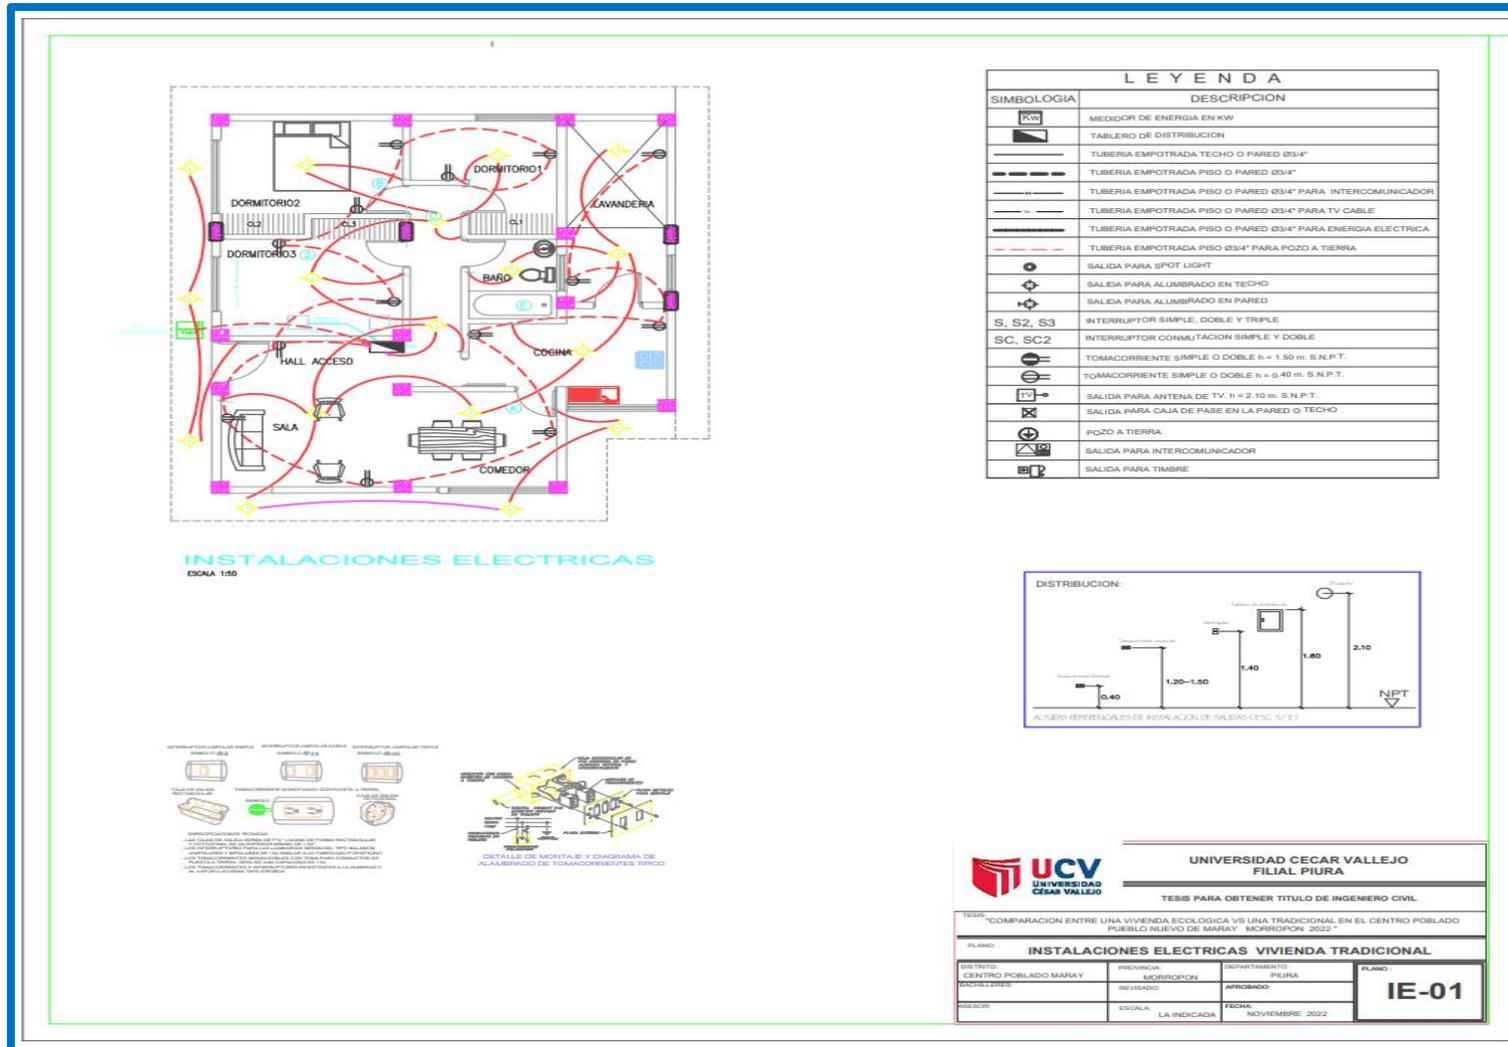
Plano de instalaciones eléctricas – vivienda tradicional (IE – 01)
